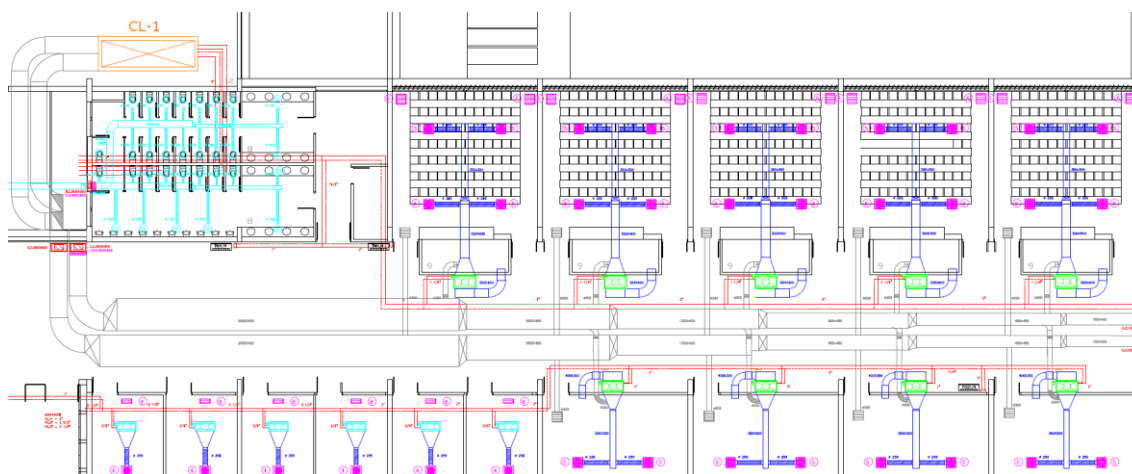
Vista de la climatizadora CL-1 en la planta segunda. Fuente: Elab. propia.
